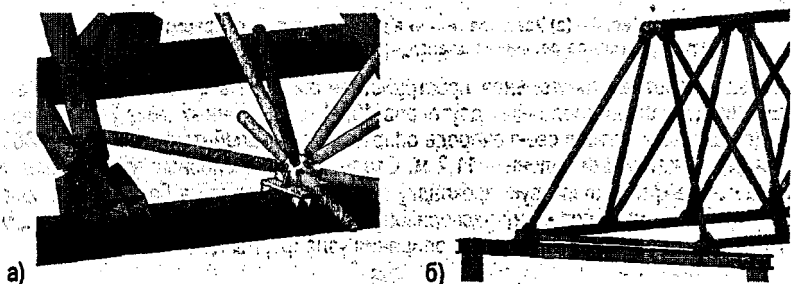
(а) Узел опирания нижнего пояса структурной плиты на нижний пояс фермы; (б) конструкция опирания пространственной фермы на колонны
